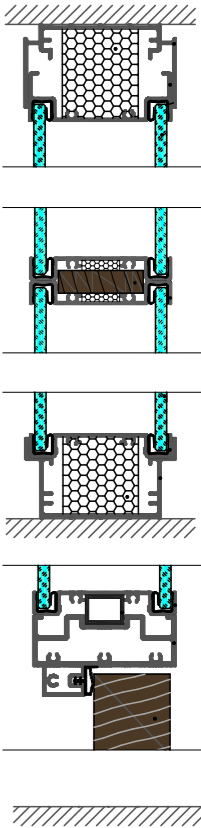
DETAIL NAPOJENÍ DVEŘÍ NA PROSKLENÝ SEGMENT
